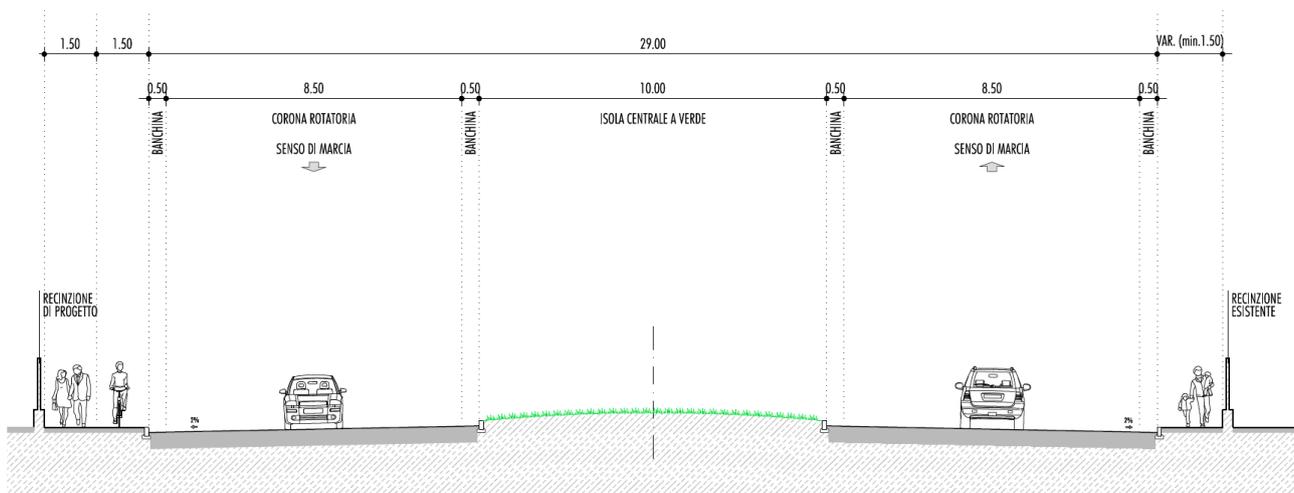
INTERSEZIONE A ROTATORIA – SEZIONE TIPO
